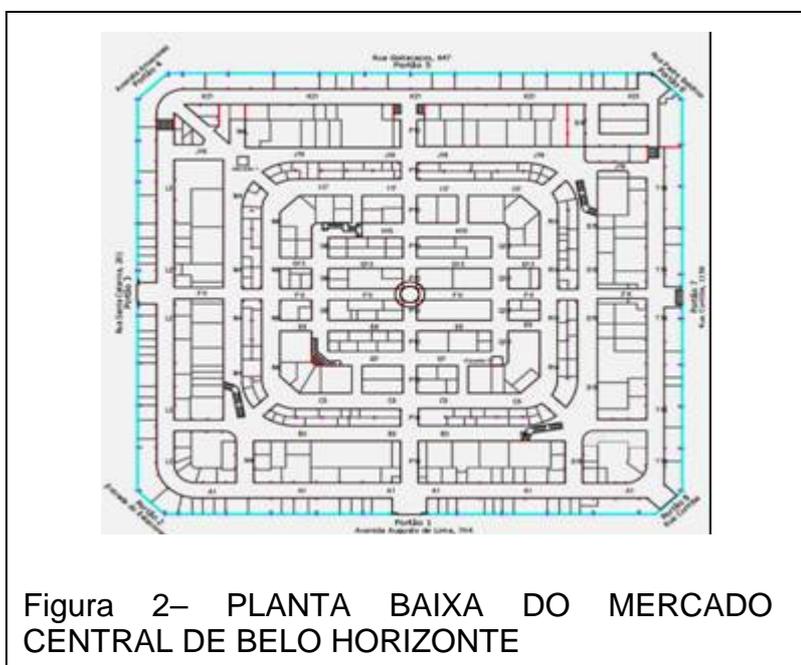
PLANTA BAIXA DO MERCADO CENTRAL DE BELO HORIZONTE
